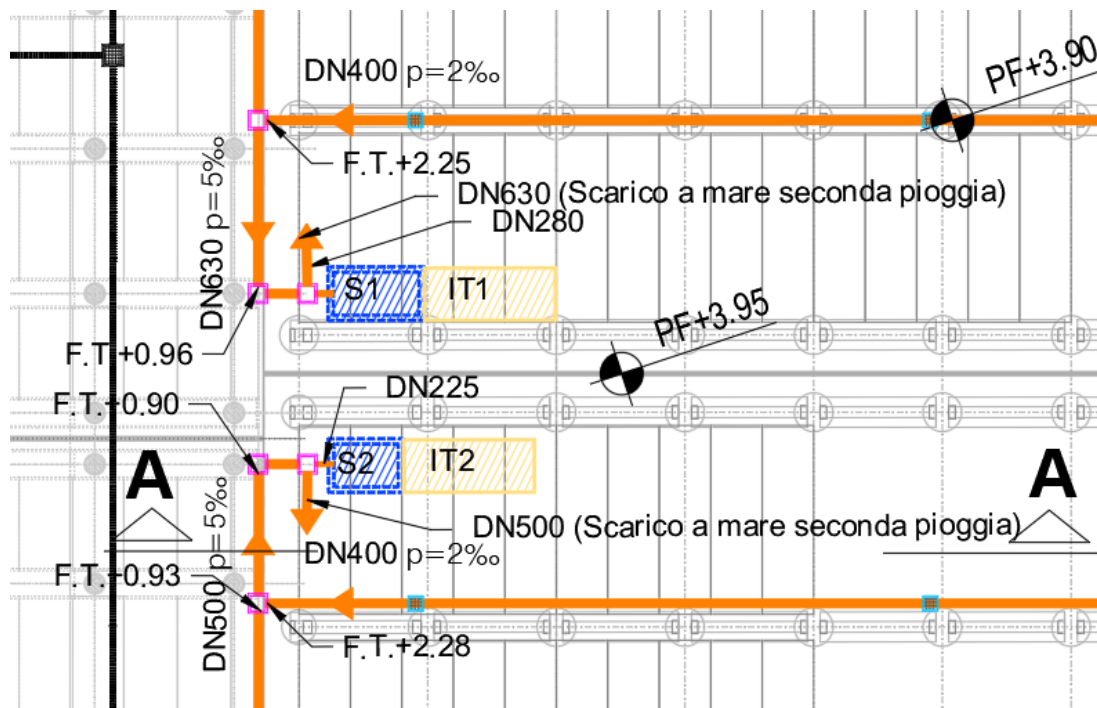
Dettaglio planimetrico della zona impianti di trattamento intervento D
